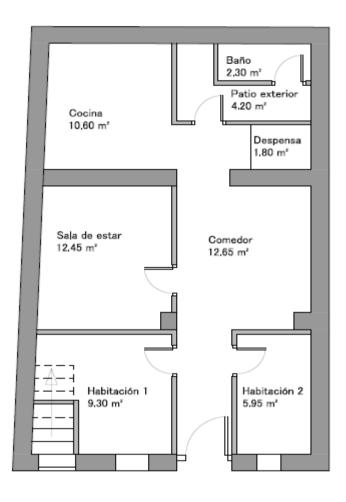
Plano planta baja de la vivienda años 1940. Fuente: Elaboración propia
